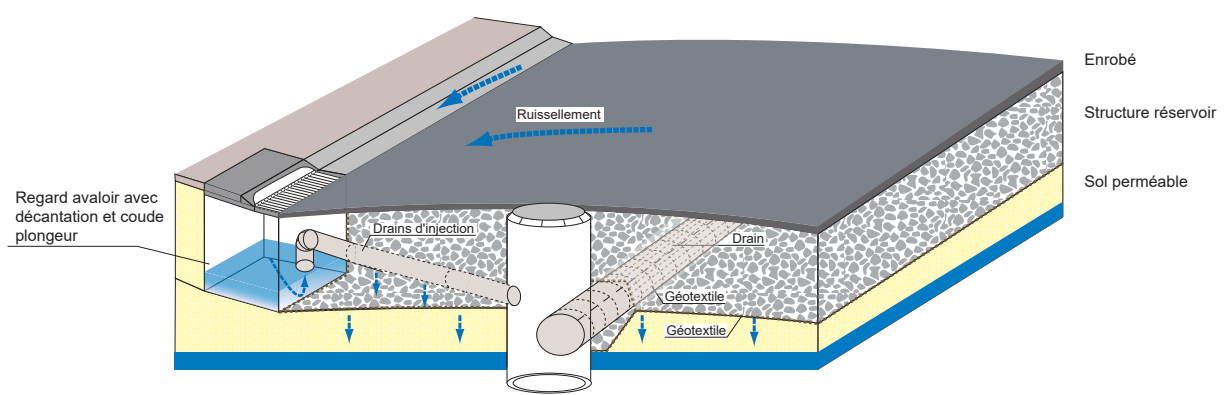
Coupe en travers type d'une chaussée à structure réservoir.
